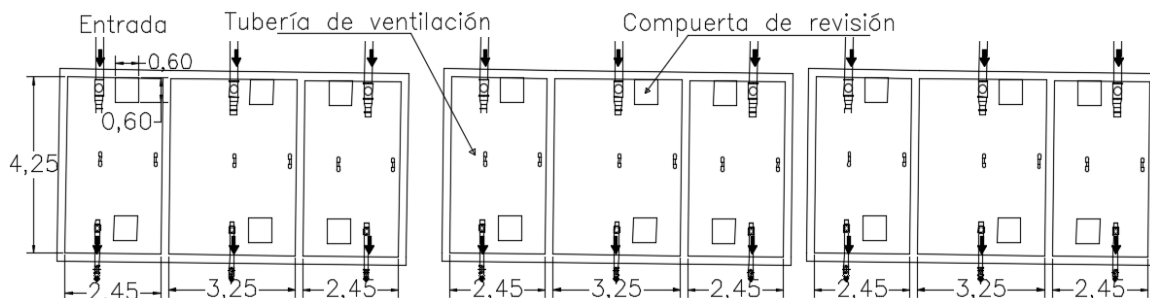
Vista en planta de los sedimentadores planta No. 14. Basado en Moscoso (2006).
